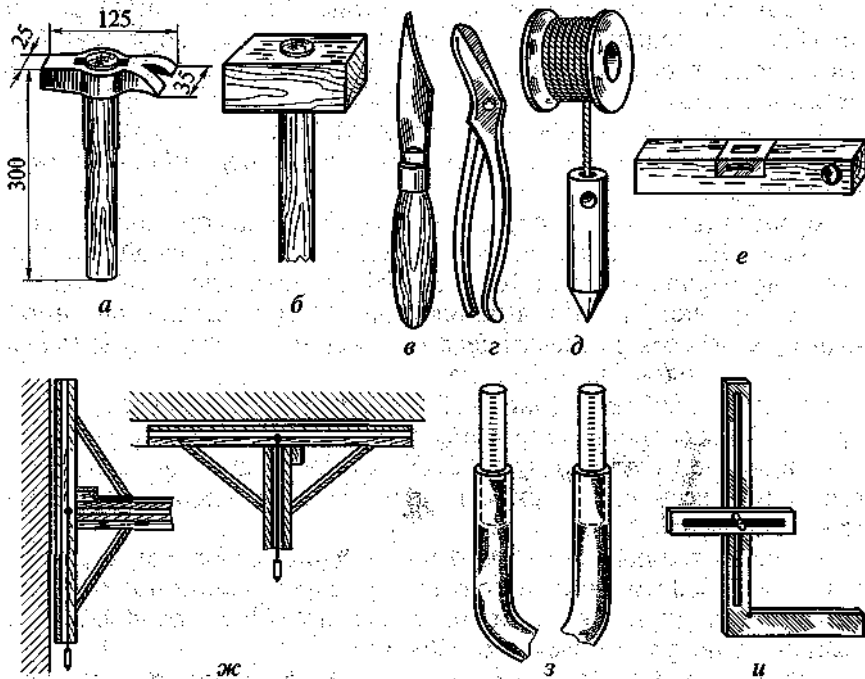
Инструменты для подготовки и проверки поверхностей:
